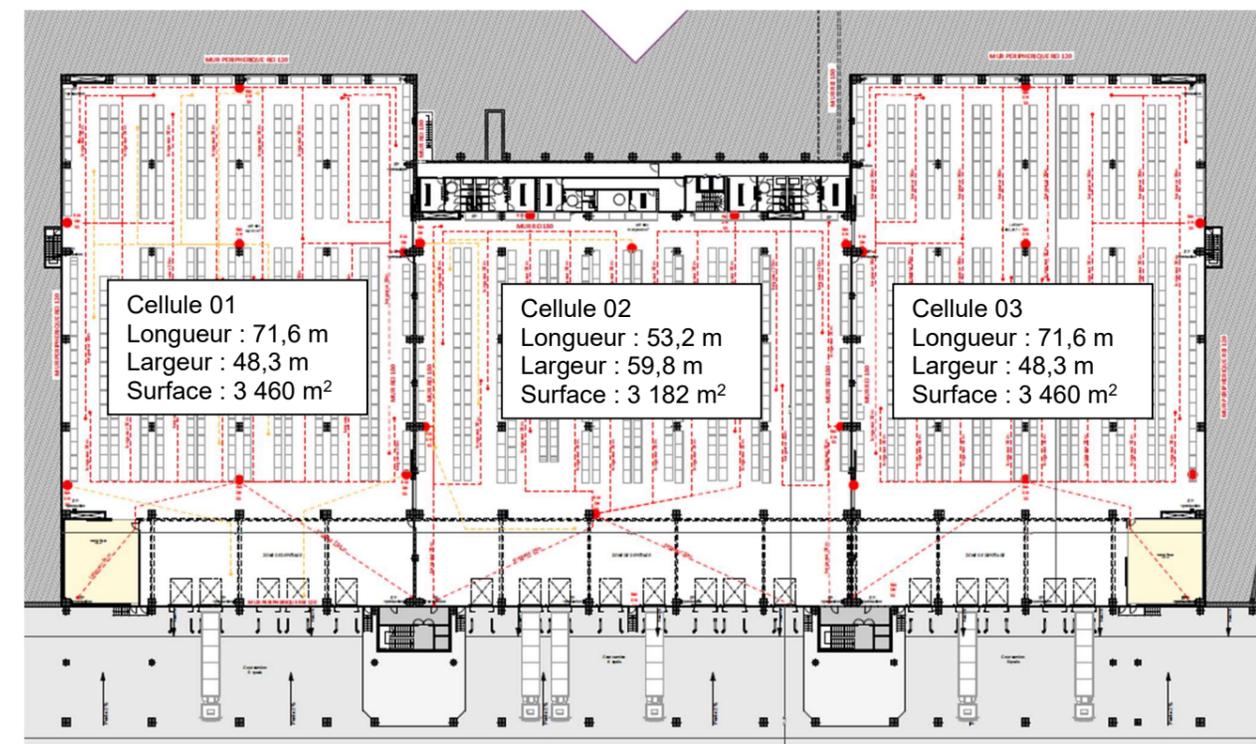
plan des cellules de l'entrepôt d'un niveau
